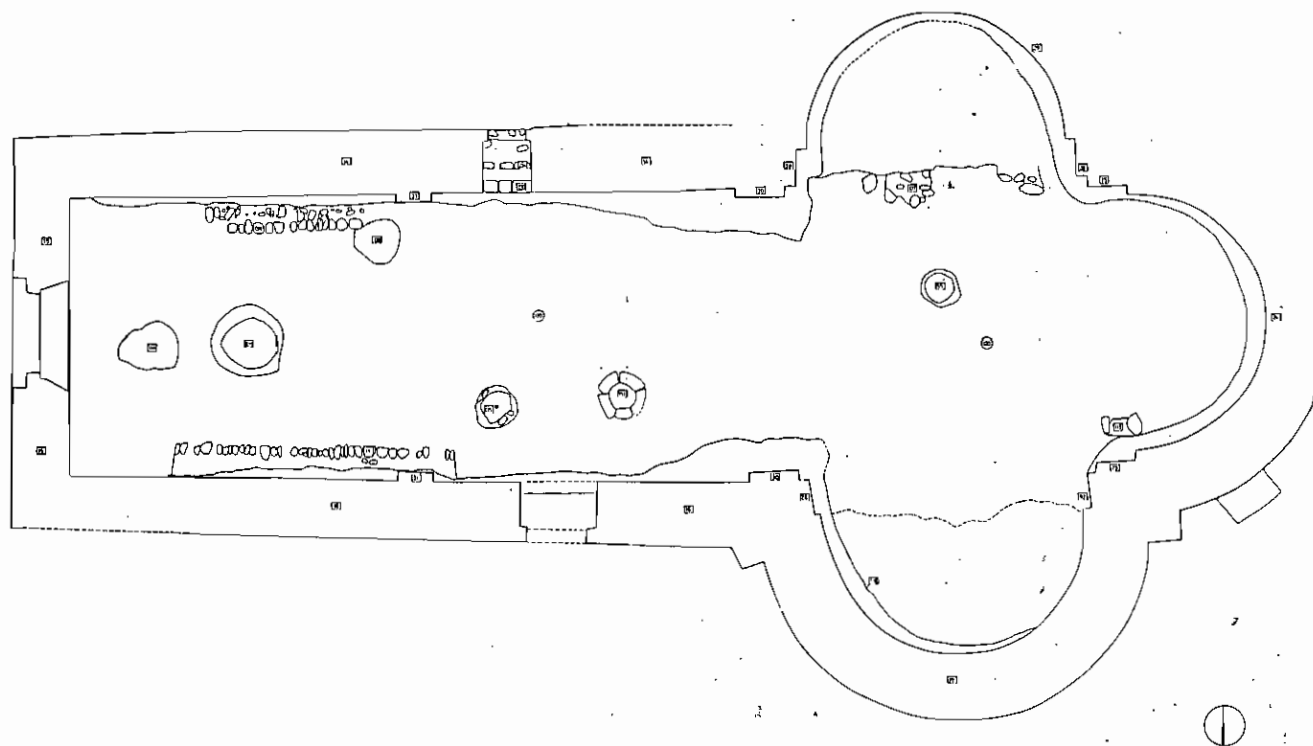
Planta de las estructuras construidas entre los siglos XII a XIV.
